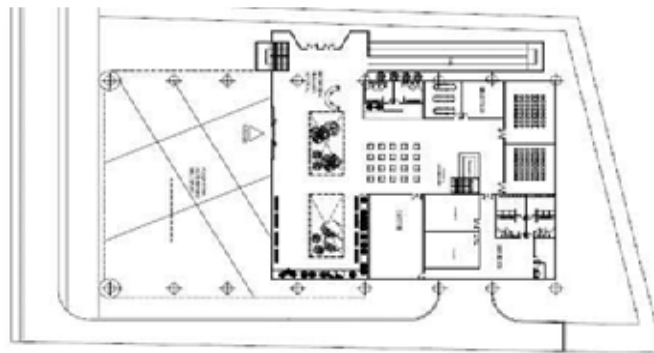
Planta baja conjunto del Gimnasio Vertical. (2018)
